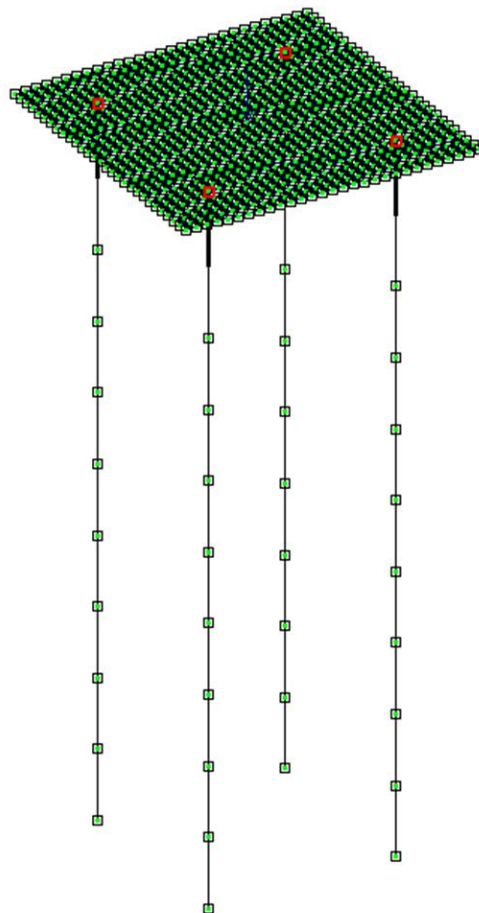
Просторова модель комплексного фундаменту на заданих фундаментних умовах будівельного майданчика при розрахунковому навантаженні $N = 1650$ кН
